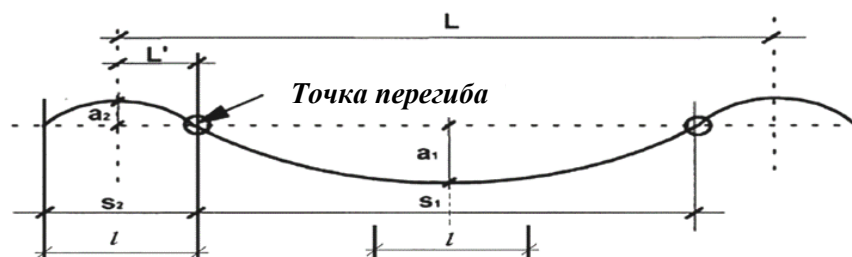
Раскладка напрягаемых арматурных элементов в пролете и на опорах
